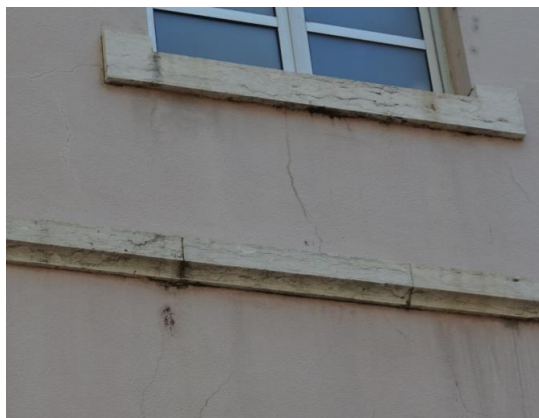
Fissuração nas cantarias da fachada [FONTE: Autor]
